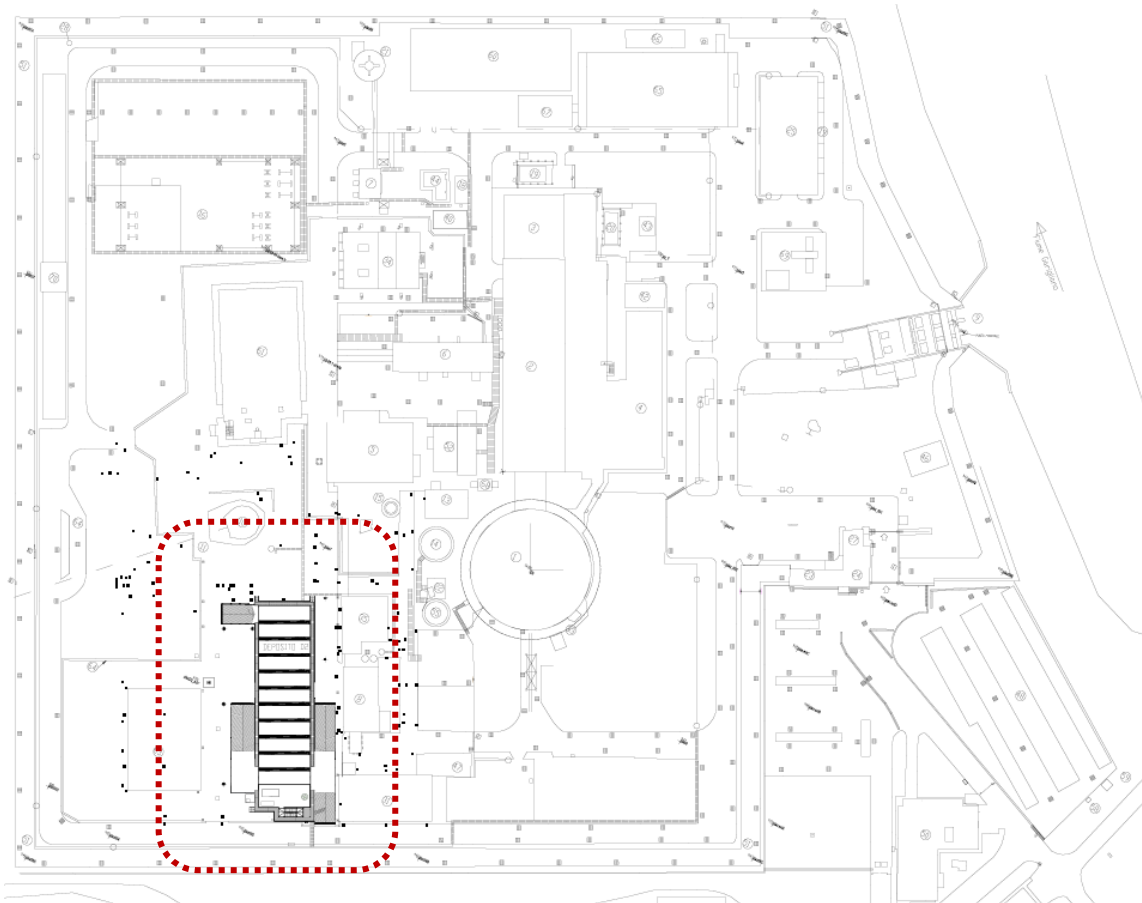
Localizzazione dell'opera all'interno del perimetro della Centrale (estratta da elaborato GRDT01380 "Planimetria di sito post operam")
